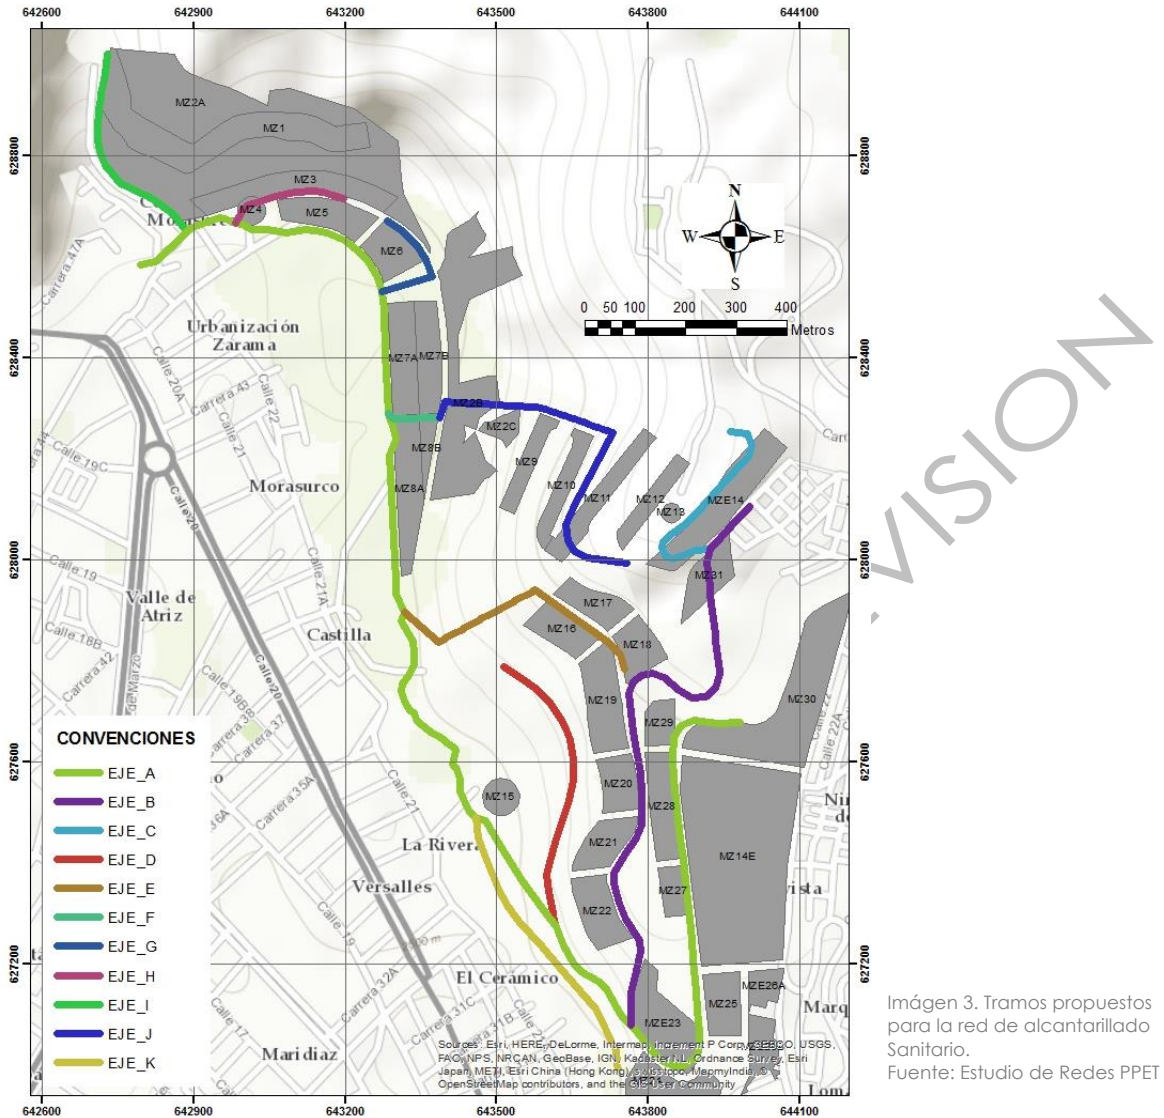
Tramos propuestos para la red de alcantarillado Sanitario.
